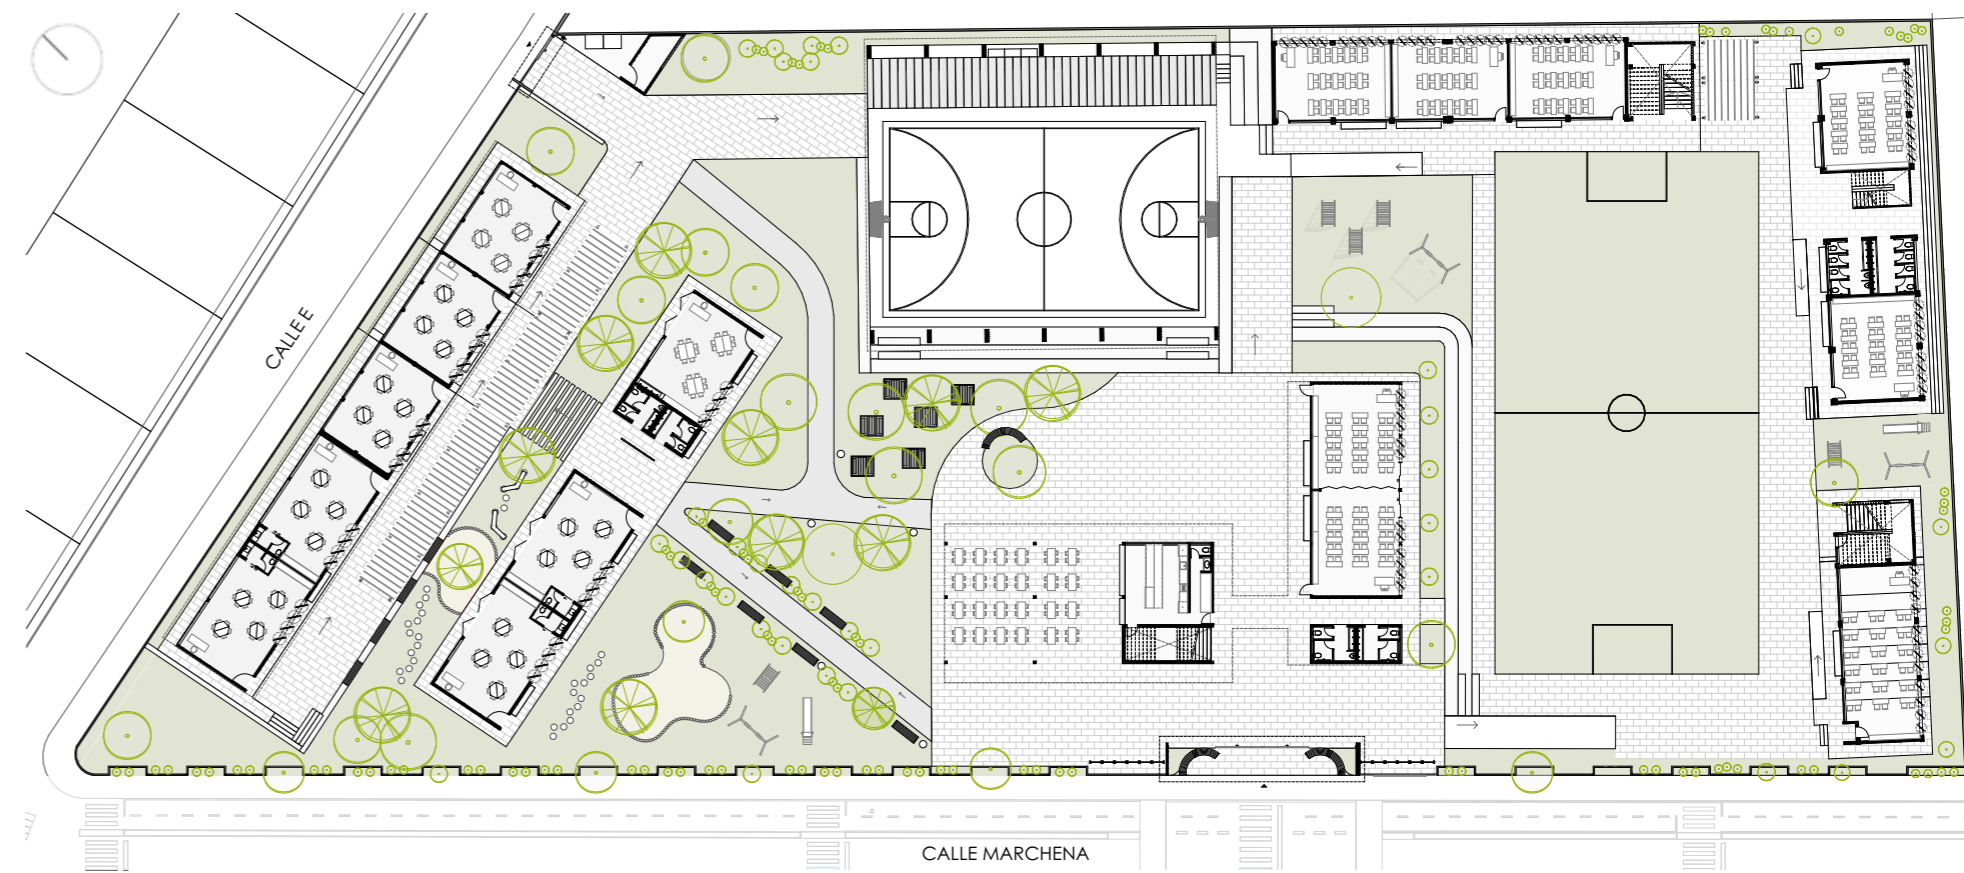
Planta baja general - Propuesta. Fuente: Elaboración propia.
